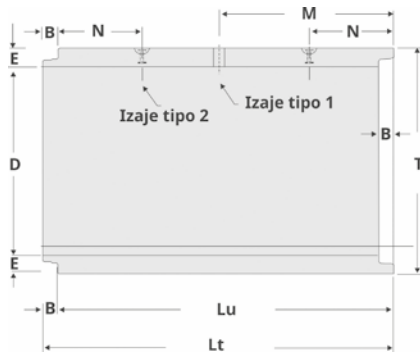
Geometría de las tuberías con diámetros mayores a 1200 m
